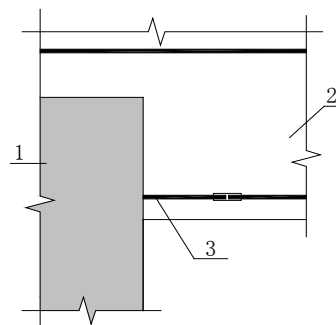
后浇连梁与预制剪力墙连接构造示意
